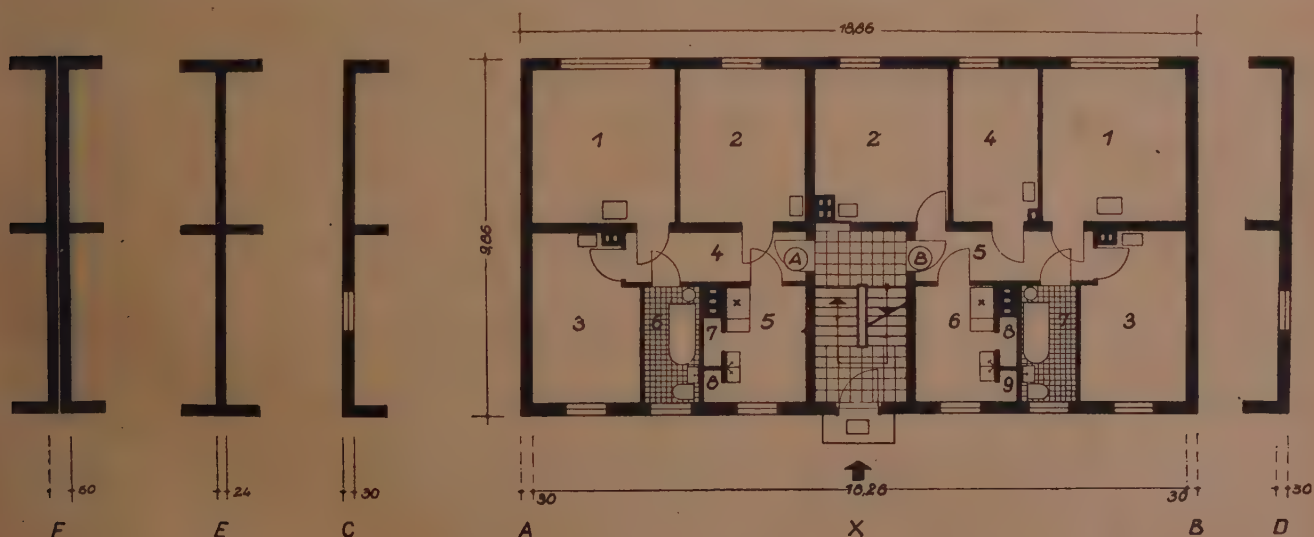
Sektion W 56/18 Leipzig - Wohngeschoßgrundriß
